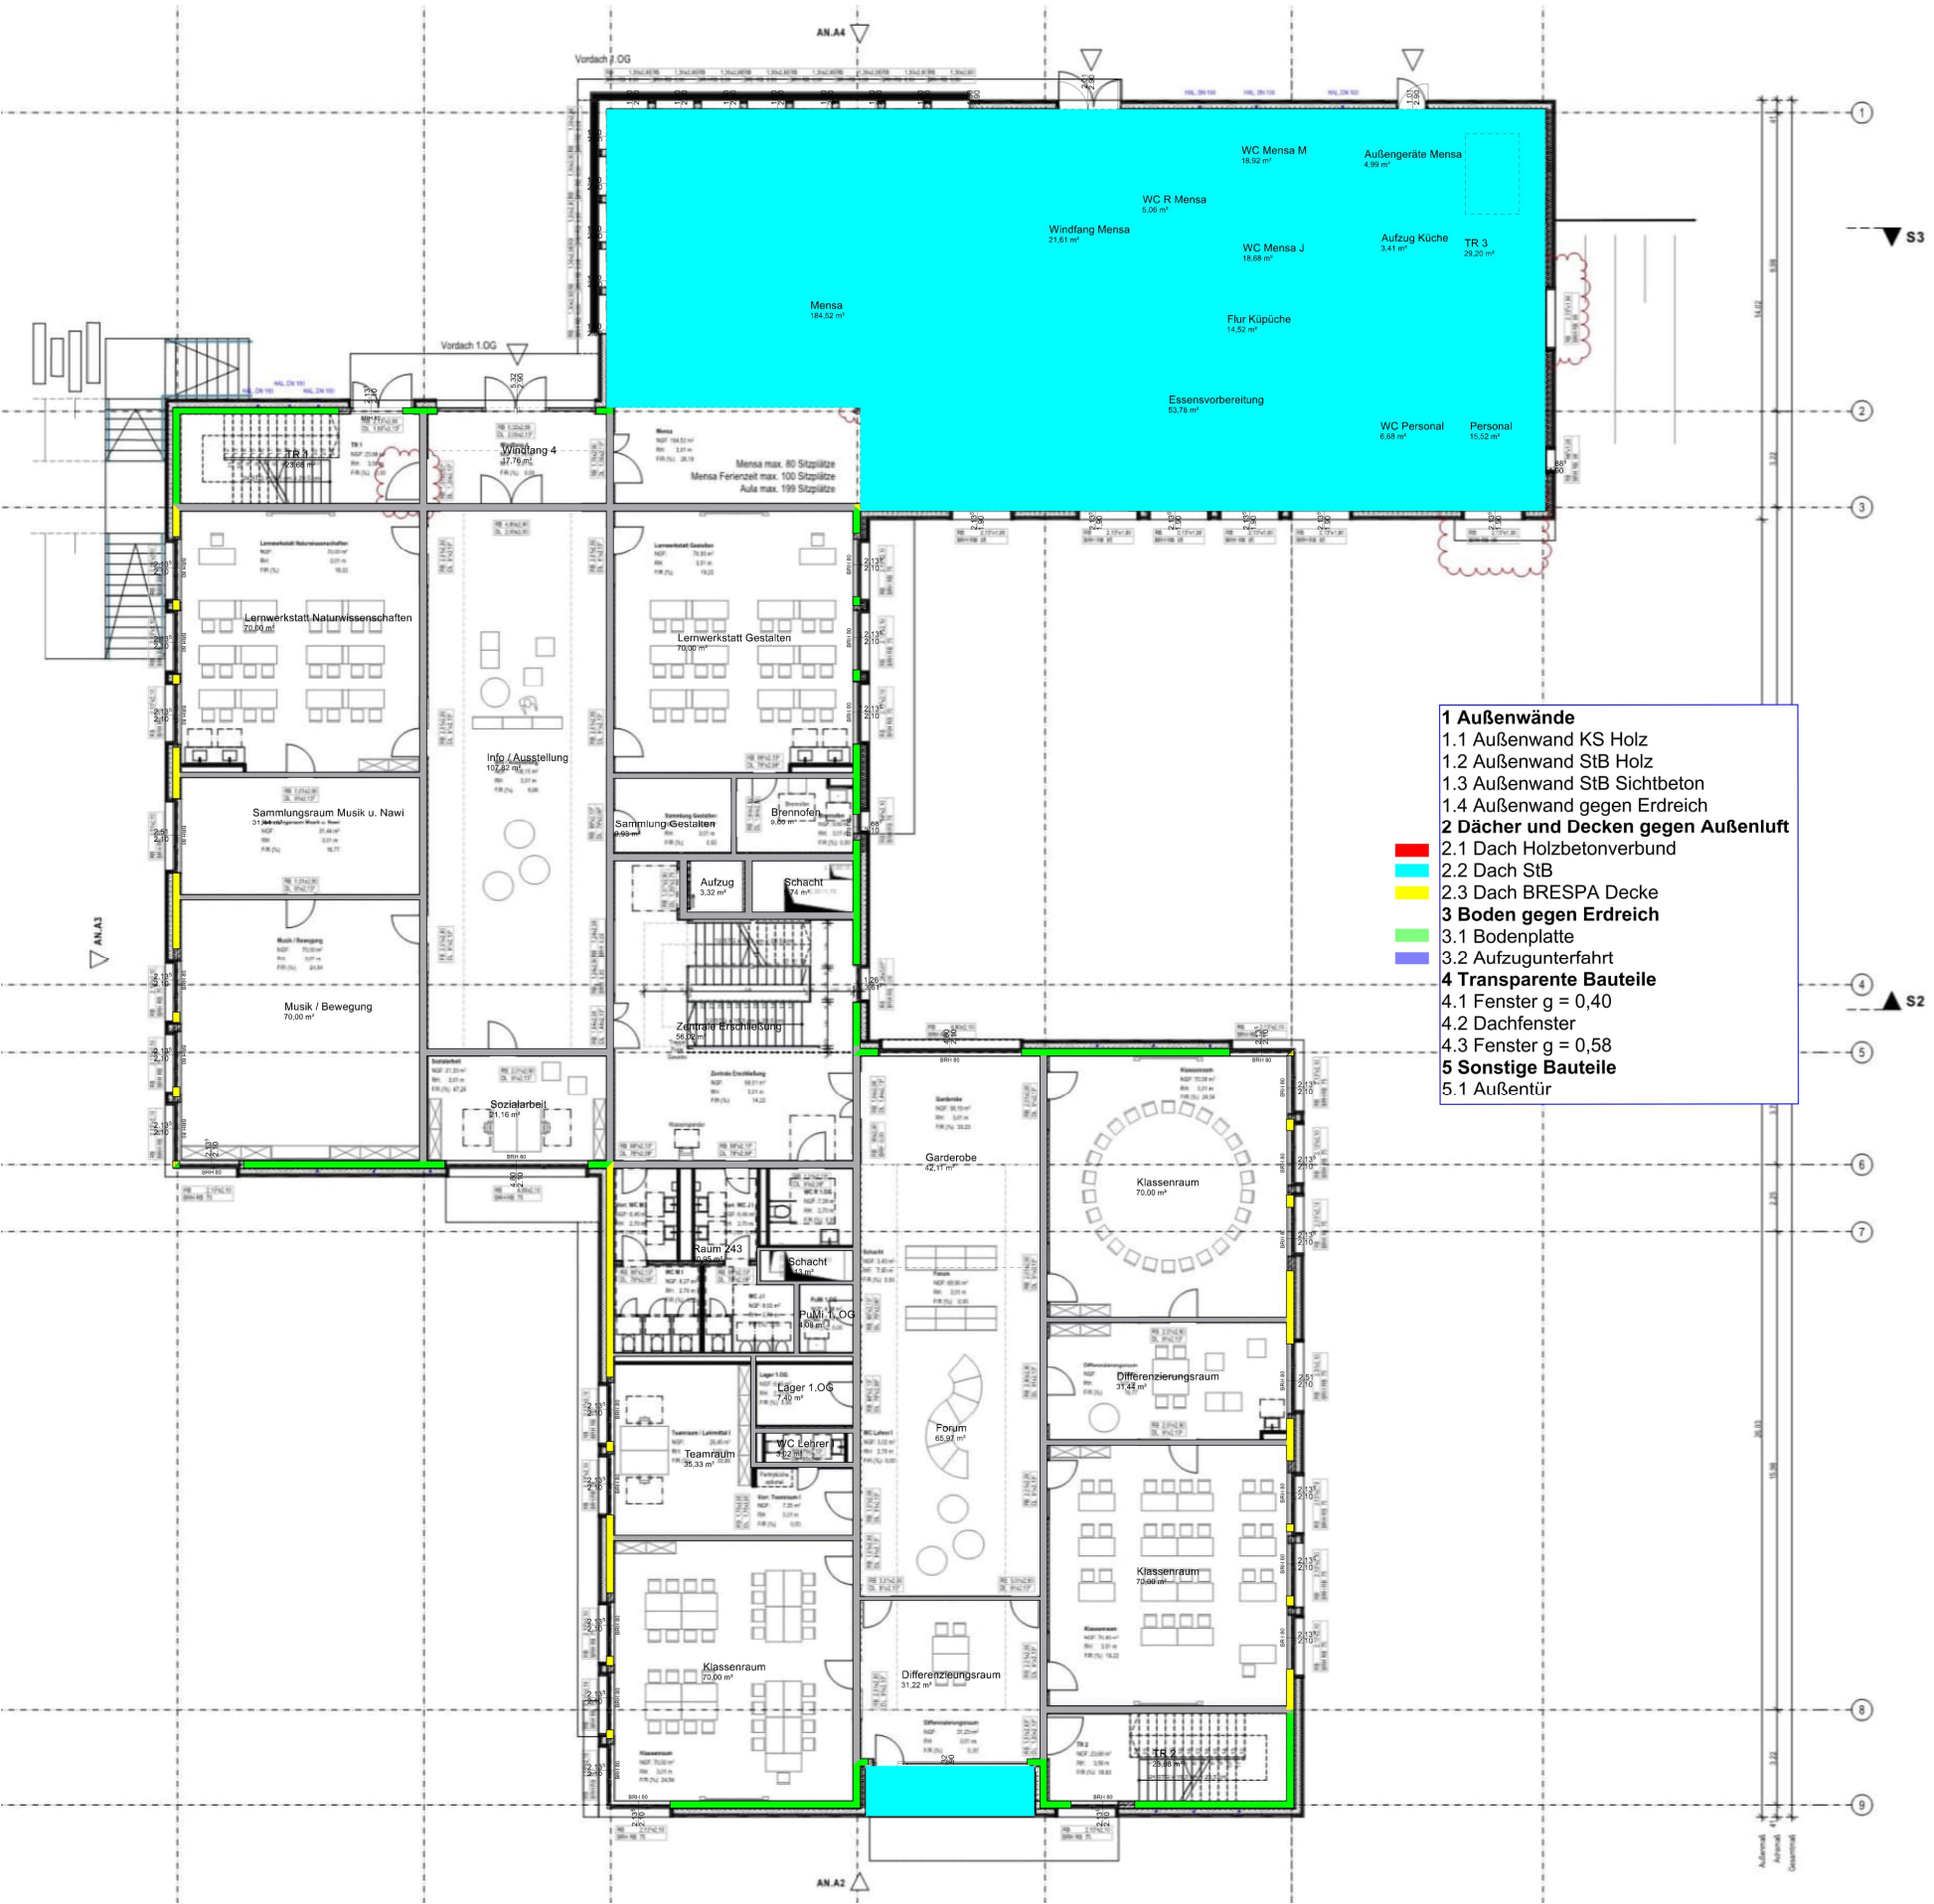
Bauteile Dachflächen Grundriss 1. OG
